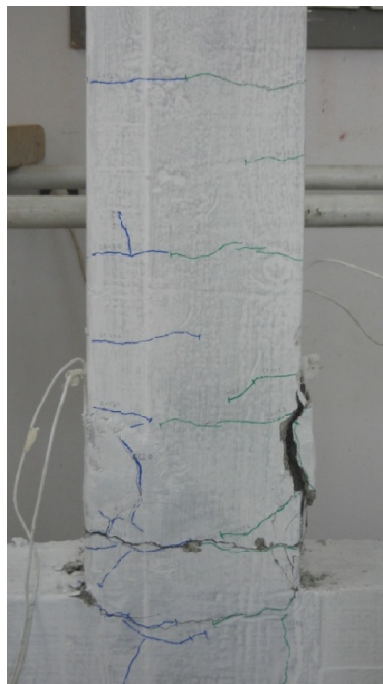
Zona comprimată de beton – zdrobire inițială a betonului comprimat pentru elementul C1C
